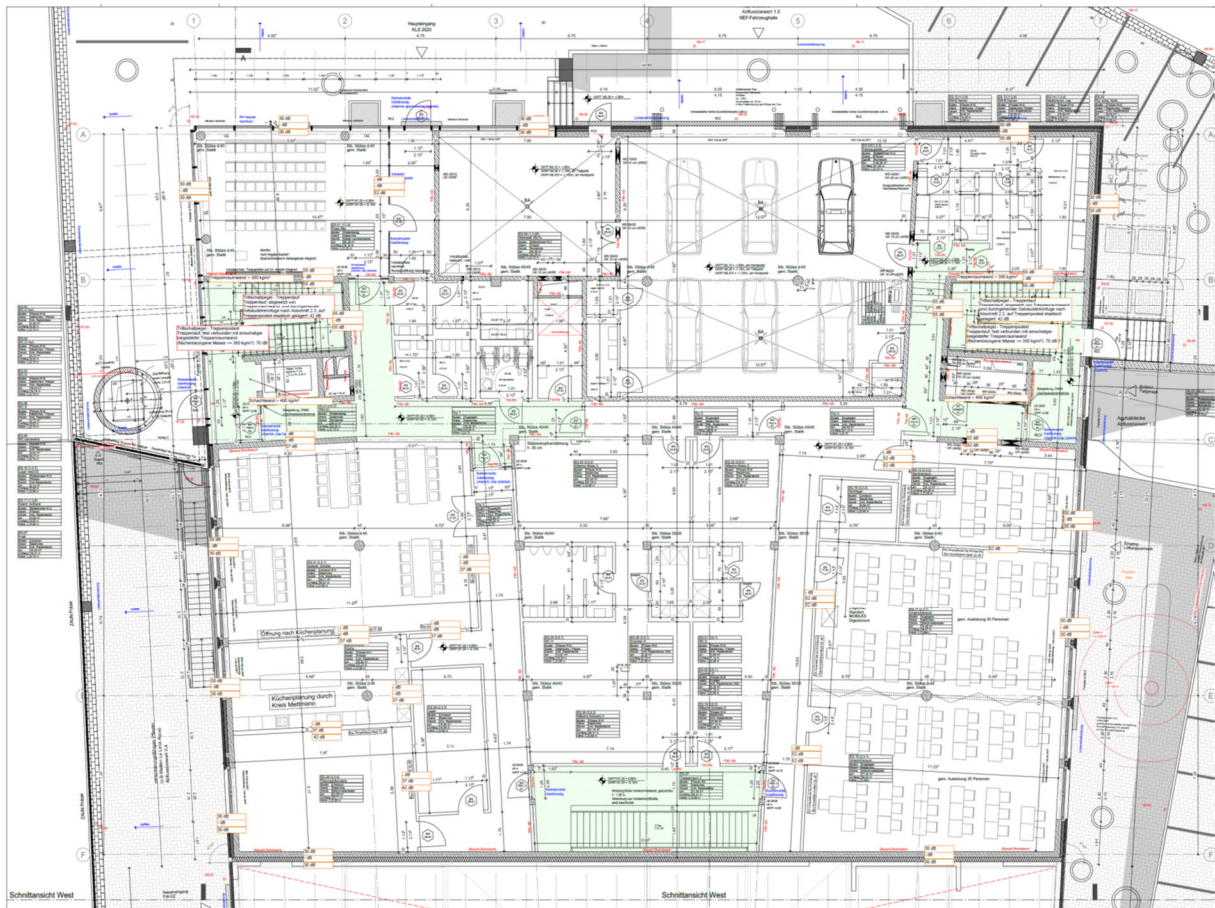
Grundriss Feuerwehrschule Lehrbereich Theorie
